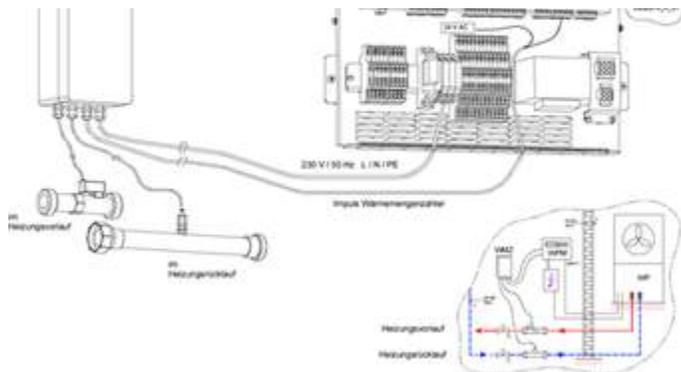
Componenti idraulici ed elettrici del contatore di calore
